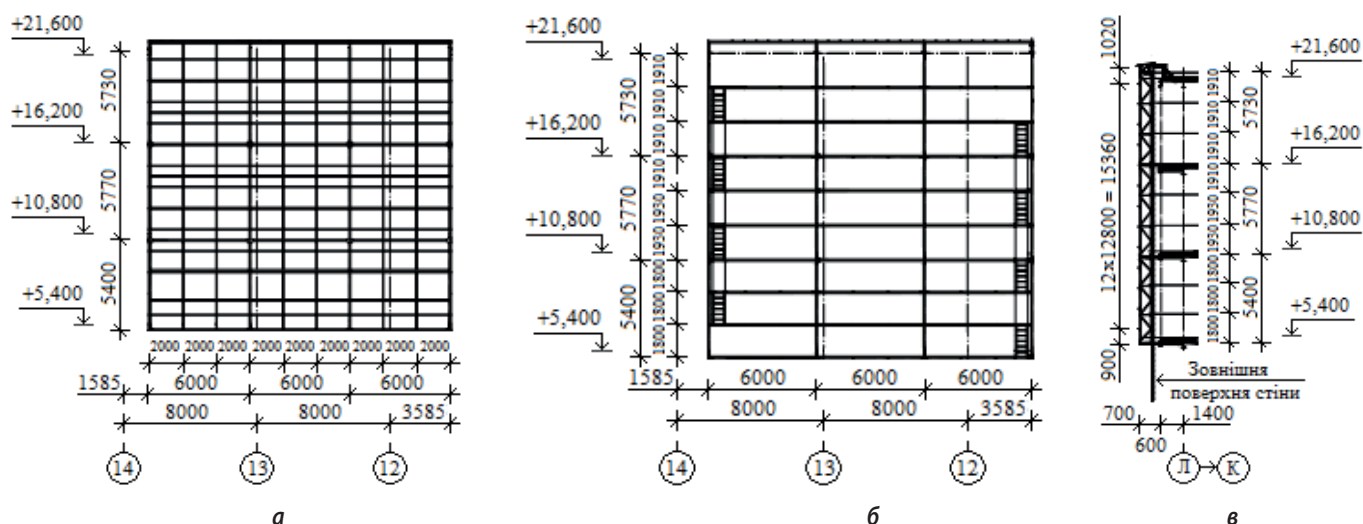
Конструктивні елементи каркаса відеоекрану:
